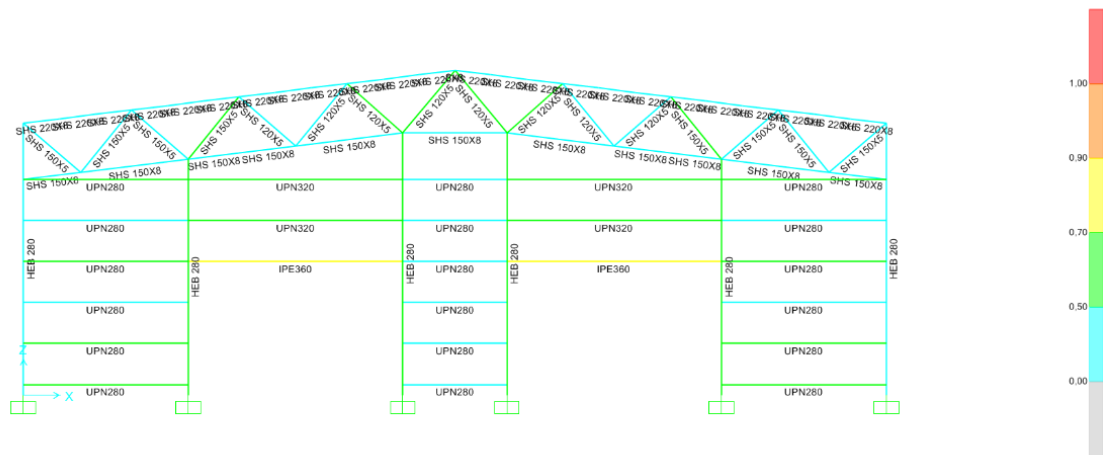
aprovechamientos pórtico fachada 1 ($y=0$)
